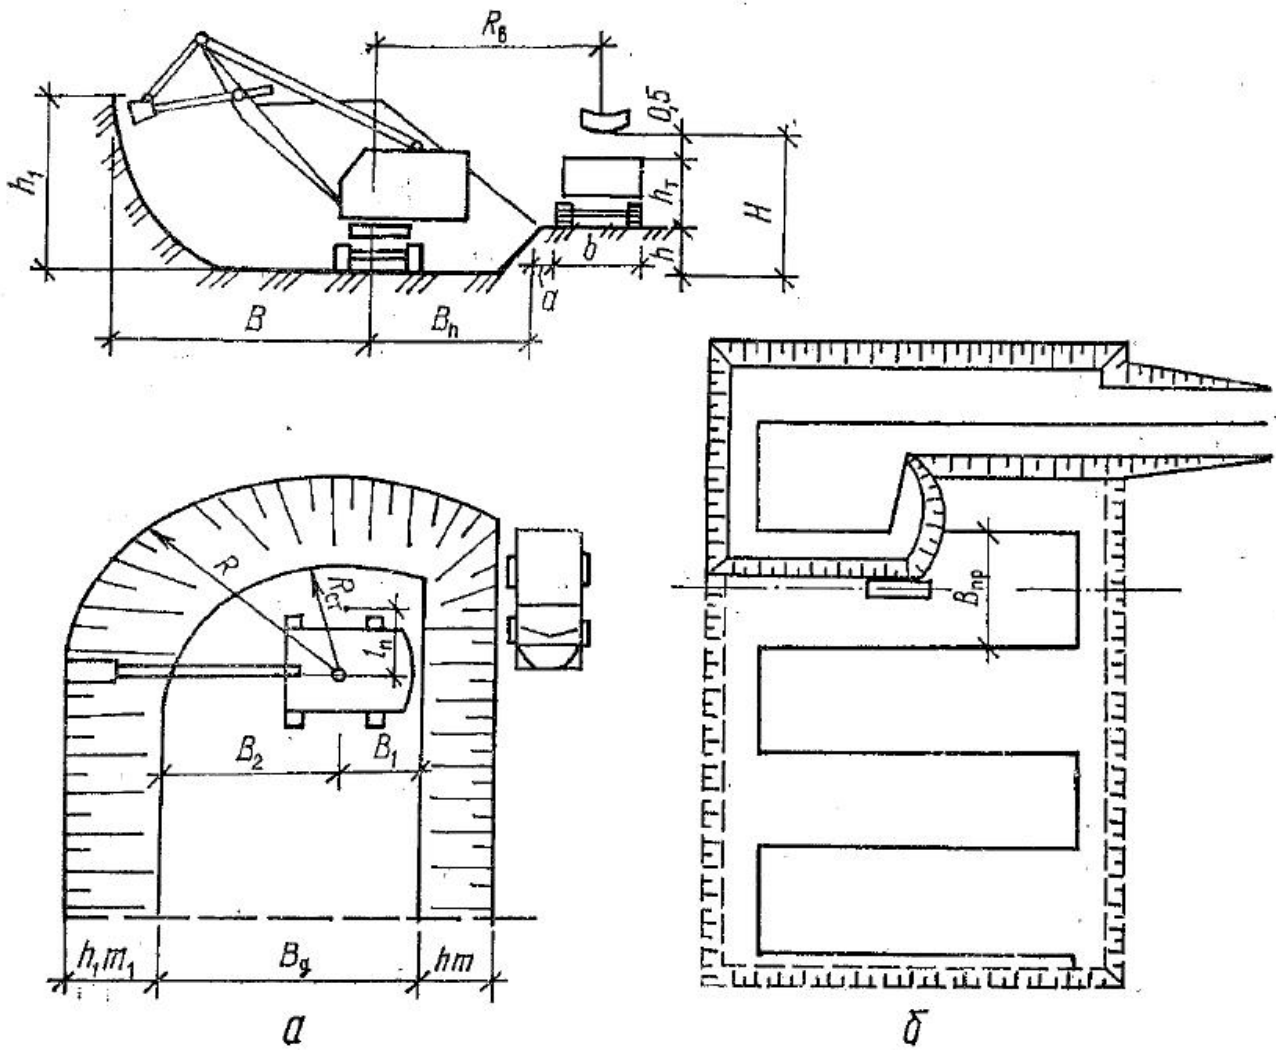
Схема разработки котлована боковыми проходками с расположением транспортных средств выше уровня подошвы забоя: а – поперечный разрез и план забоя; б – план котлована.
